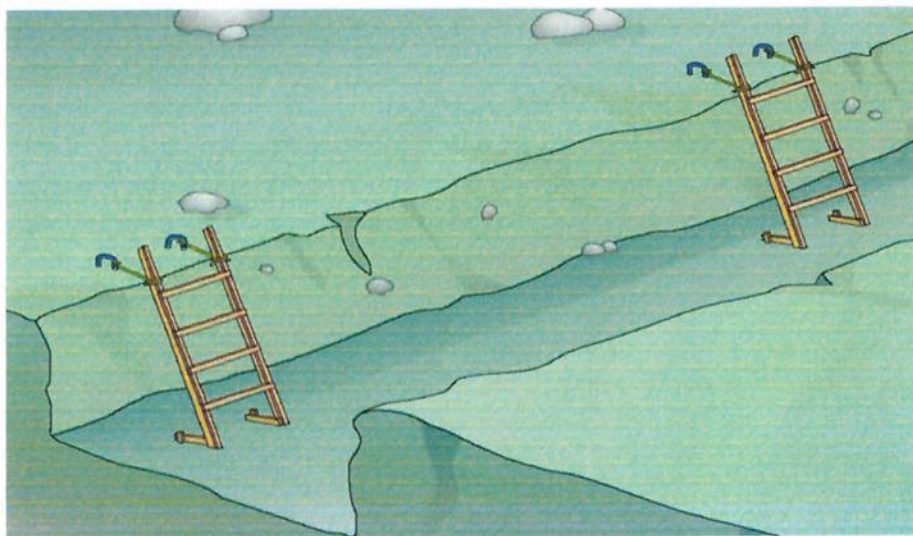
Instalação de escada em escavação com mais de 1,25 metros
